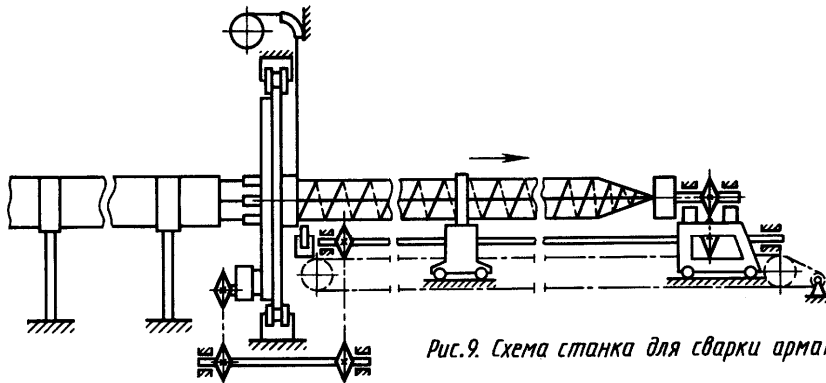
Схема станка для сварки арматурных каркасов свай
